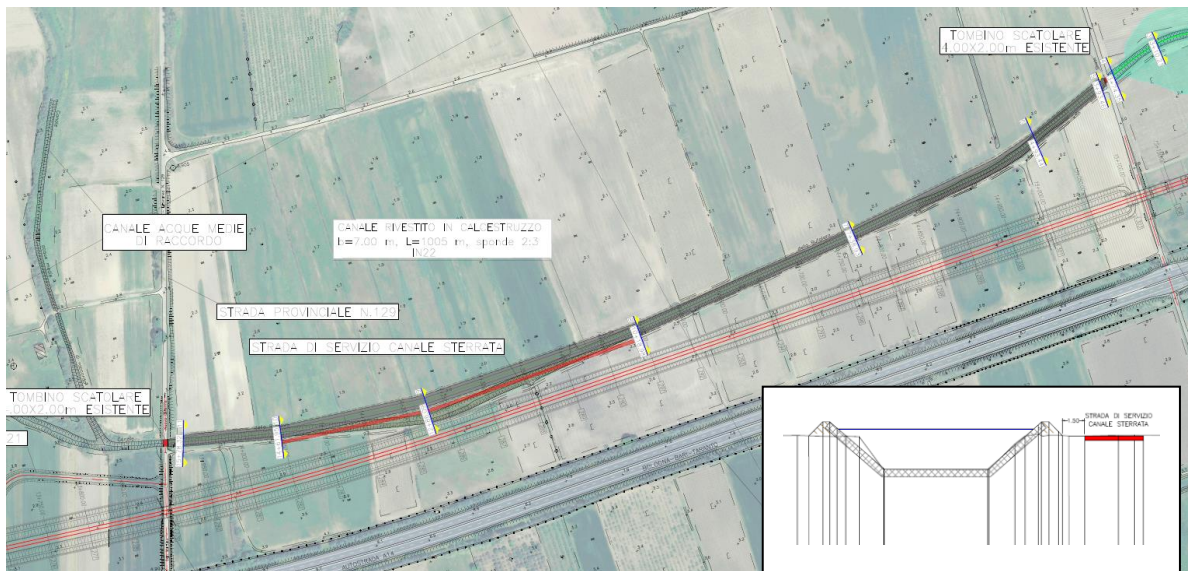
Stralcio planimetrico e sezione tipo sistemazione "Canale orientale delle Acque medie" pk 13+900-15+100
